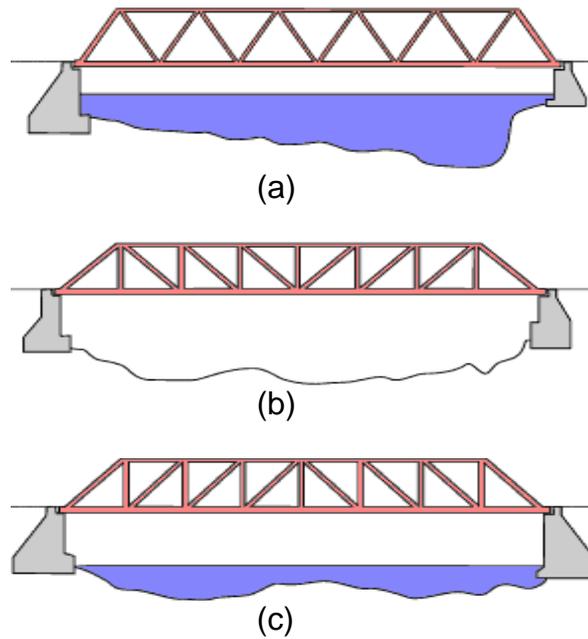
Esquemas de pontes em treliças. (a) Treliça Warren. (b) Treliça Pratt. (c) Treliça Howe. Disponível em: <[http:// www.arq.ufsc.br/arq_5661](http://www.arq.ufsc.br/arq_5661)>.
